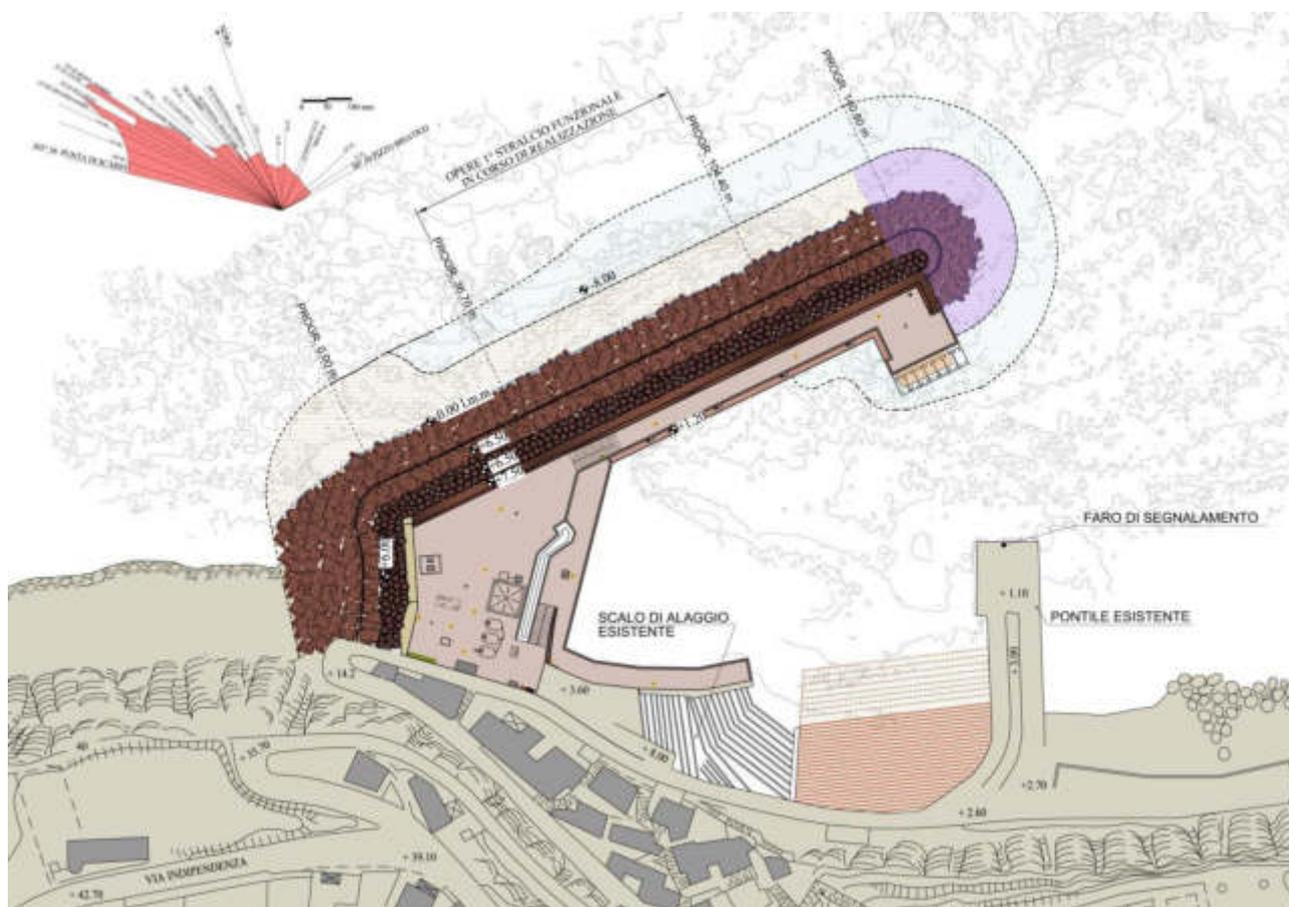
Planimetria opere previste nel progetto esecutivo di completamento
